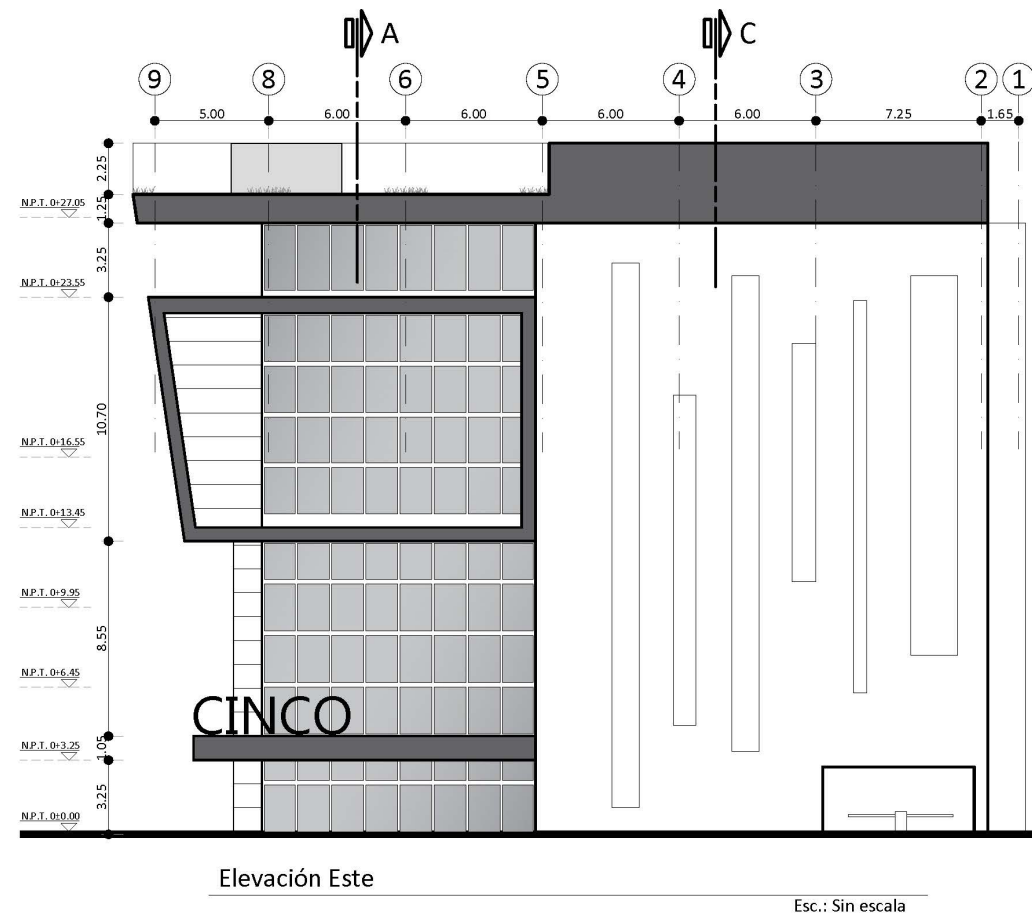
Detalle arquitectónico de elevación este. Fuente: Propia.
